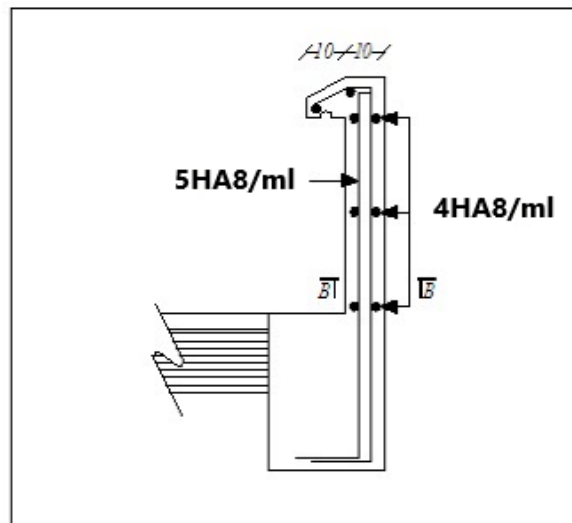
Plan de ferrailage de l'acrotère
